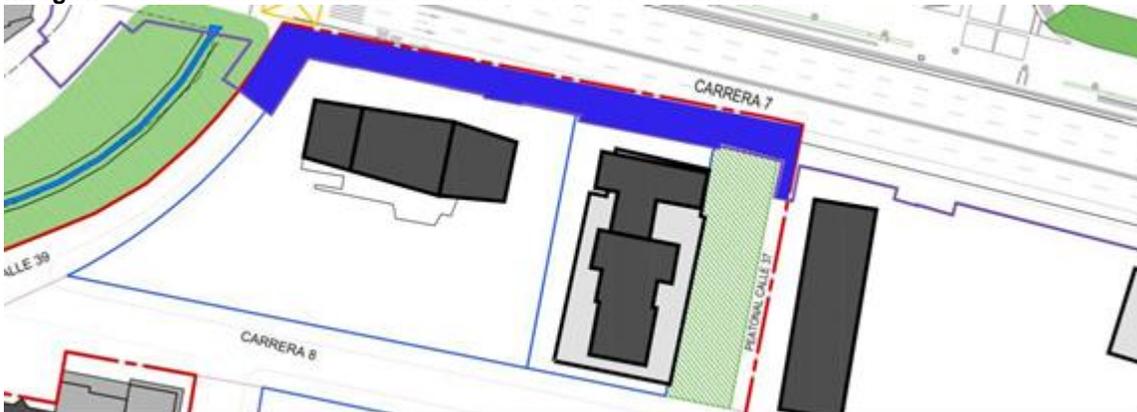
Perfil Projectado Carrera 7ª (en rojo se muestra el perfil actual)
